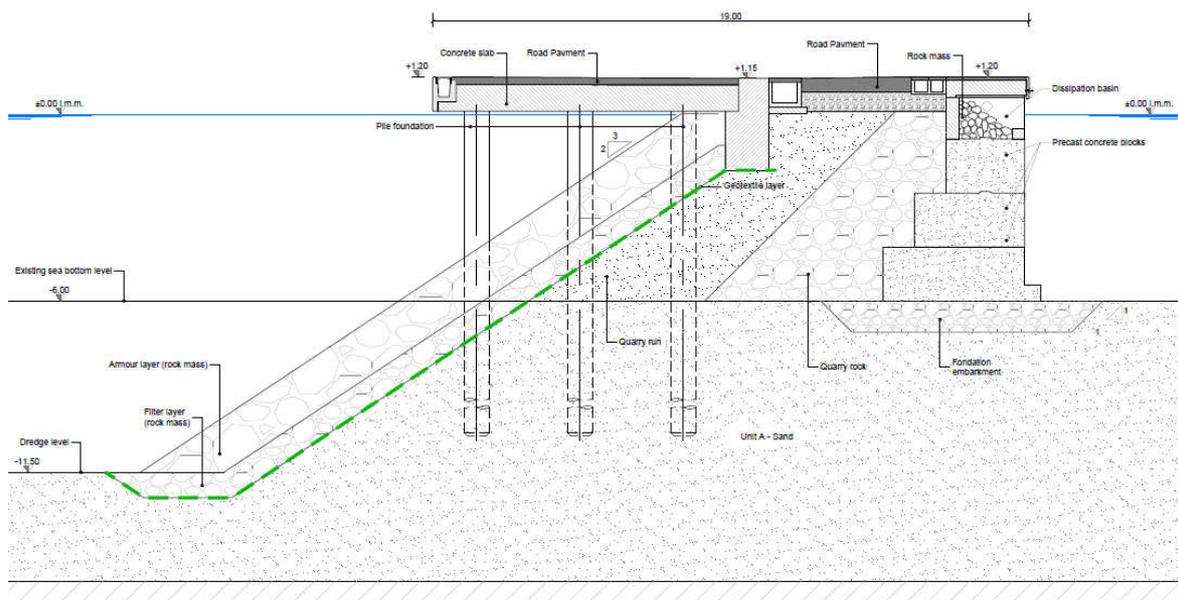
Sezione Preliminare di Progetto Struttura di Ormeggio tra lo Yacht Marina e la Darsena crociera (SEZIONE A-A)
